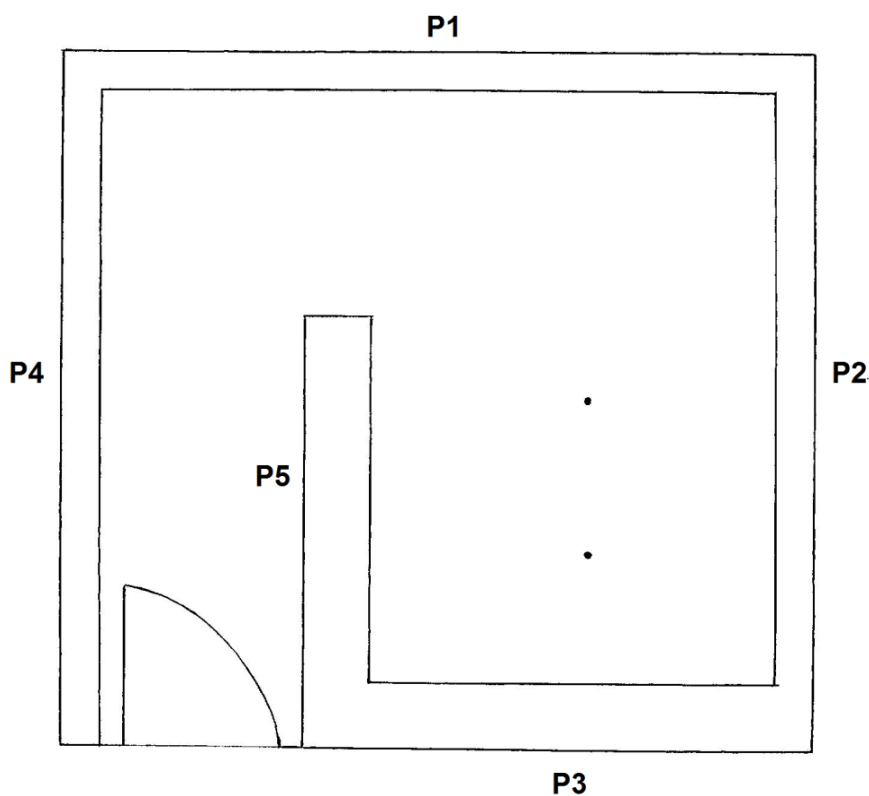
Planta da instalação de braquiterapia e identificação dos pontos de medição.
